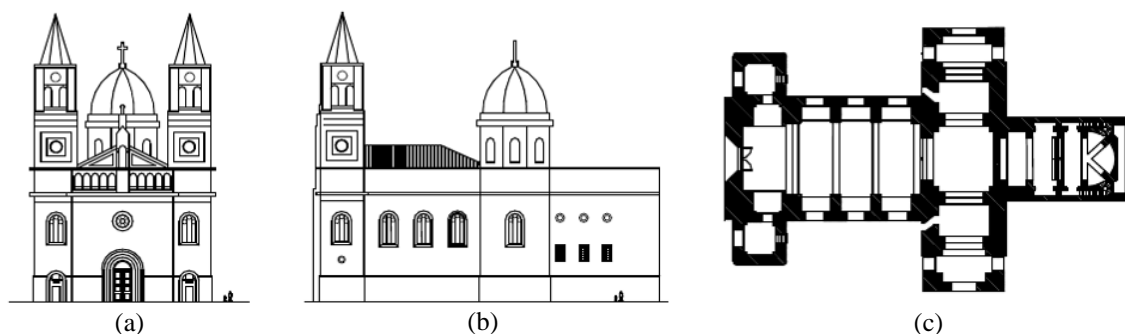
Santuário de S. Torcato: (a) fachada; (b) alçado lateral direito; (c) planta
